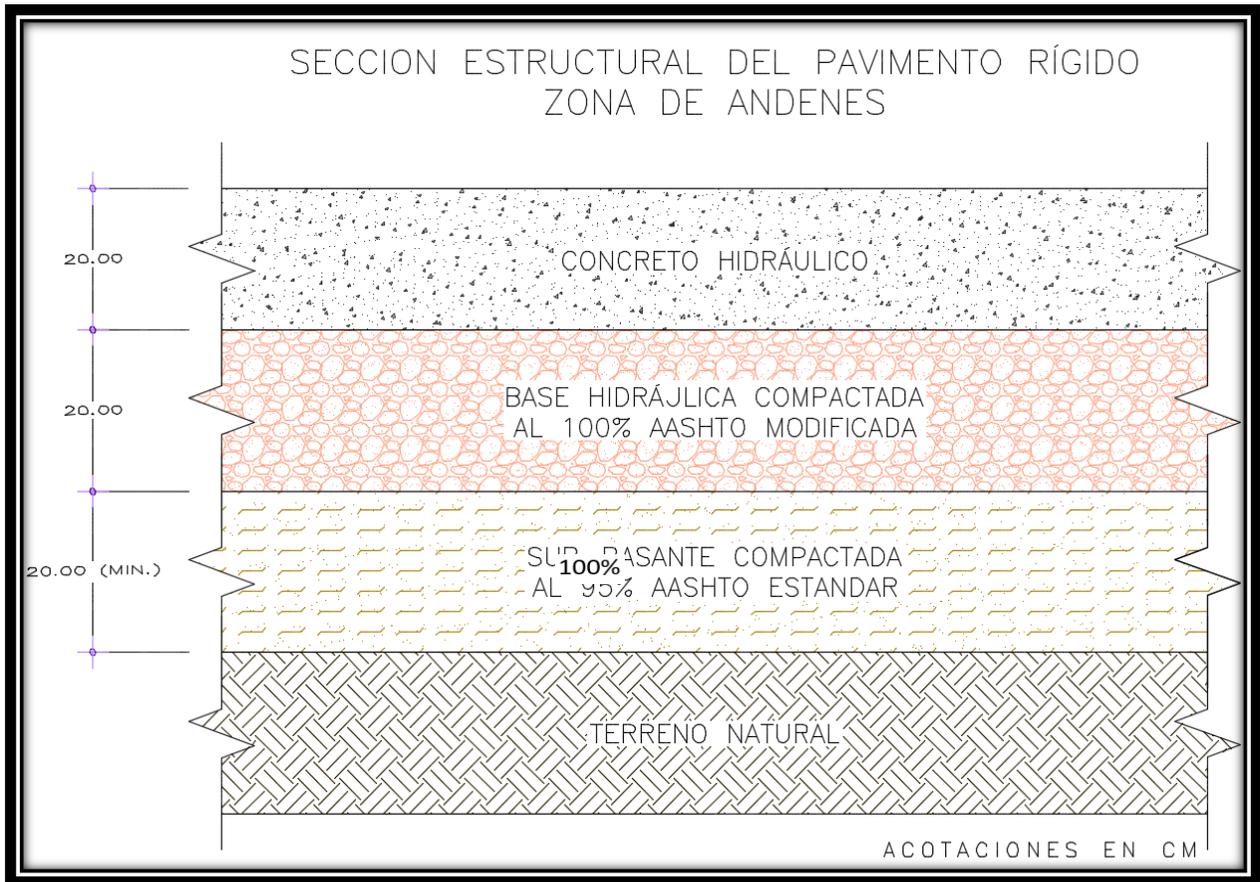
SECCION DEL PAVIMENTO EN ANDENES Y DOLLY
